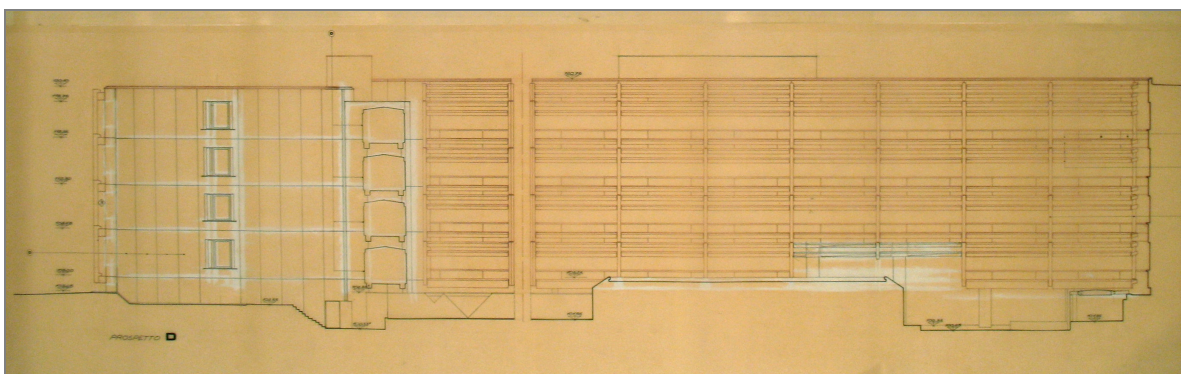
prospetto interno D (fonte CSAC – stralcio tav. 59, archivio n. 384-6)
